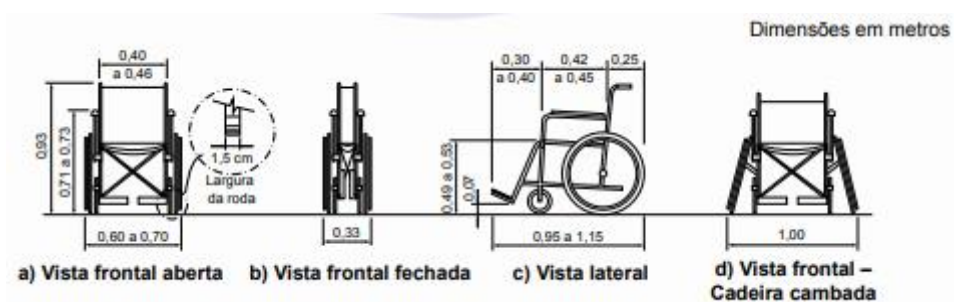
dimensões de uma cadeira de rodas. (Fonte: NBR 9050)
